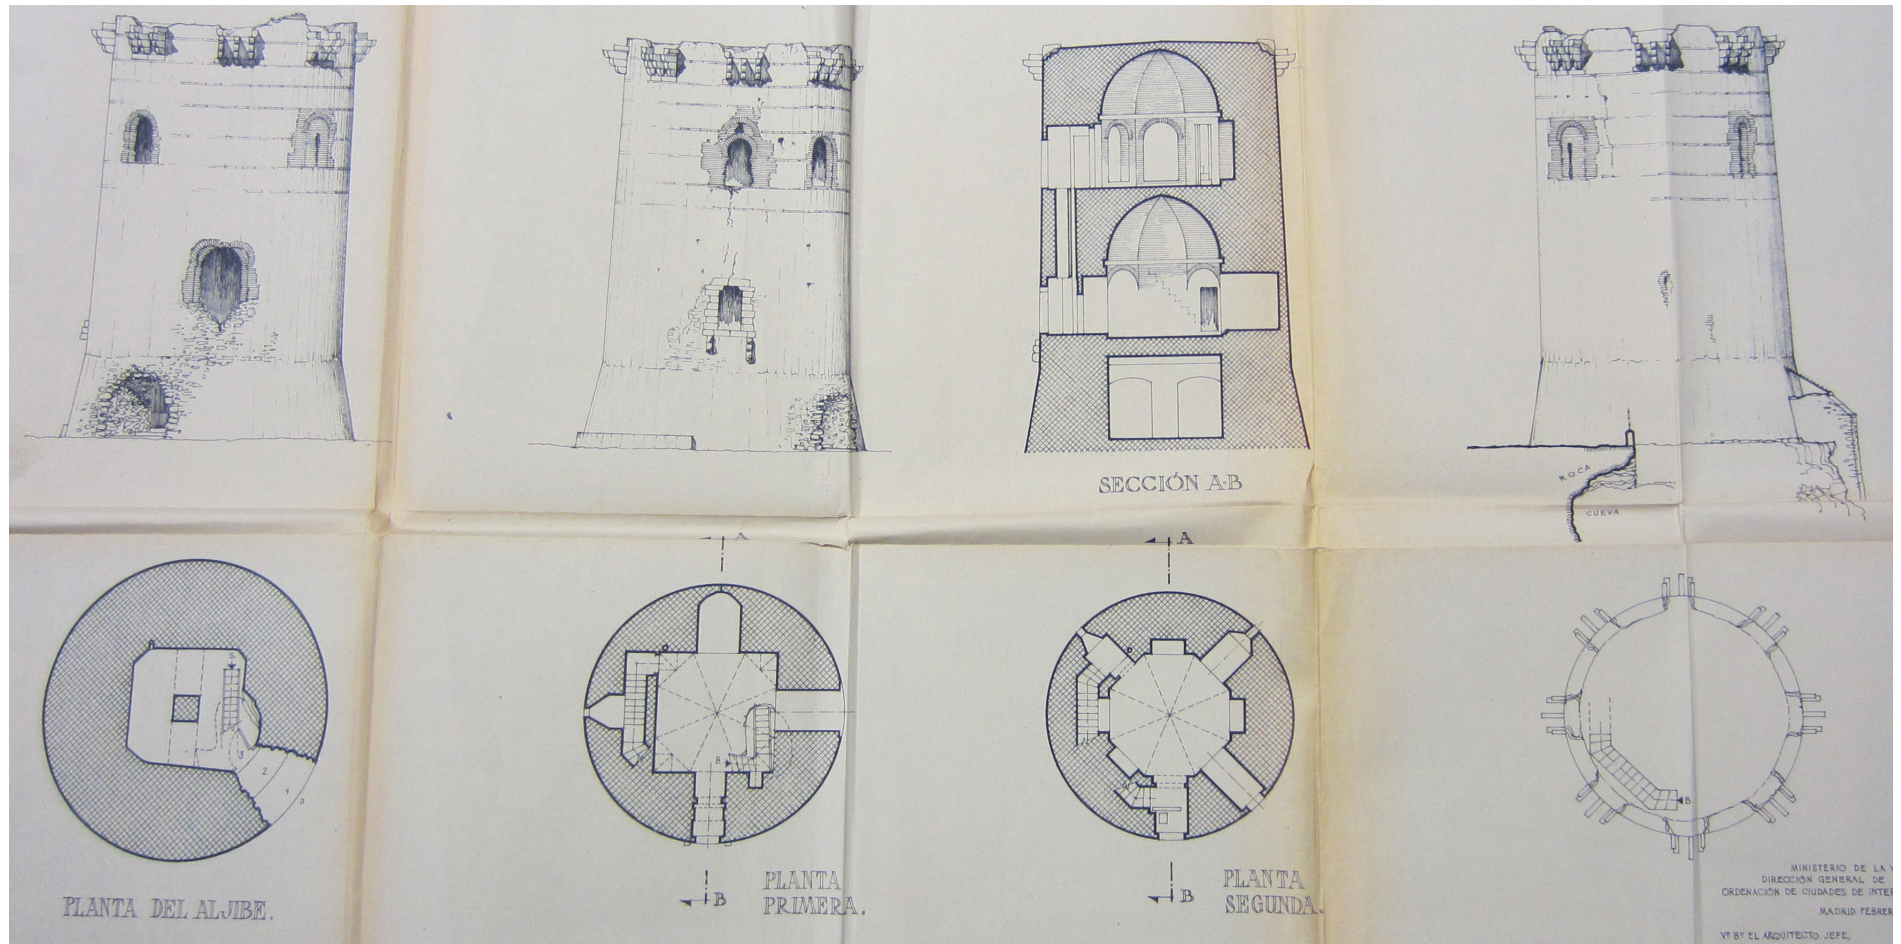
Alzados, sección y plantas del estado anterior a la intervención. (Según Gómez de las Heras)
